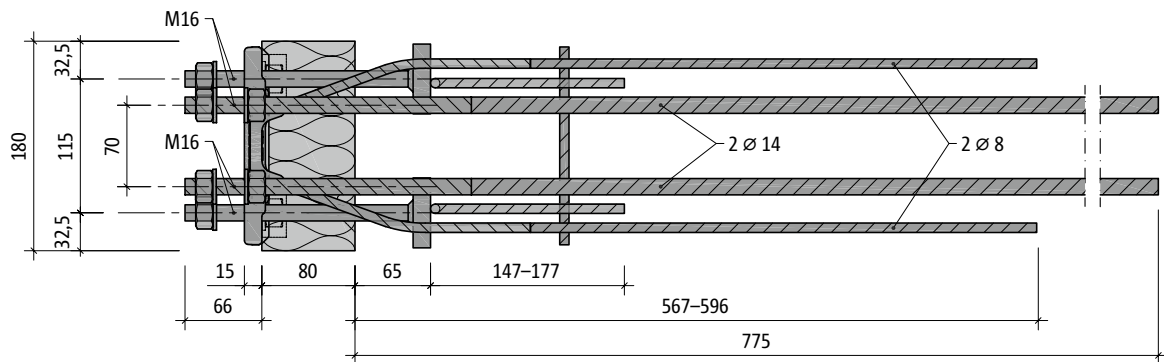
Schöck Isokorb® T type SK-M1-V1 : plan de base
